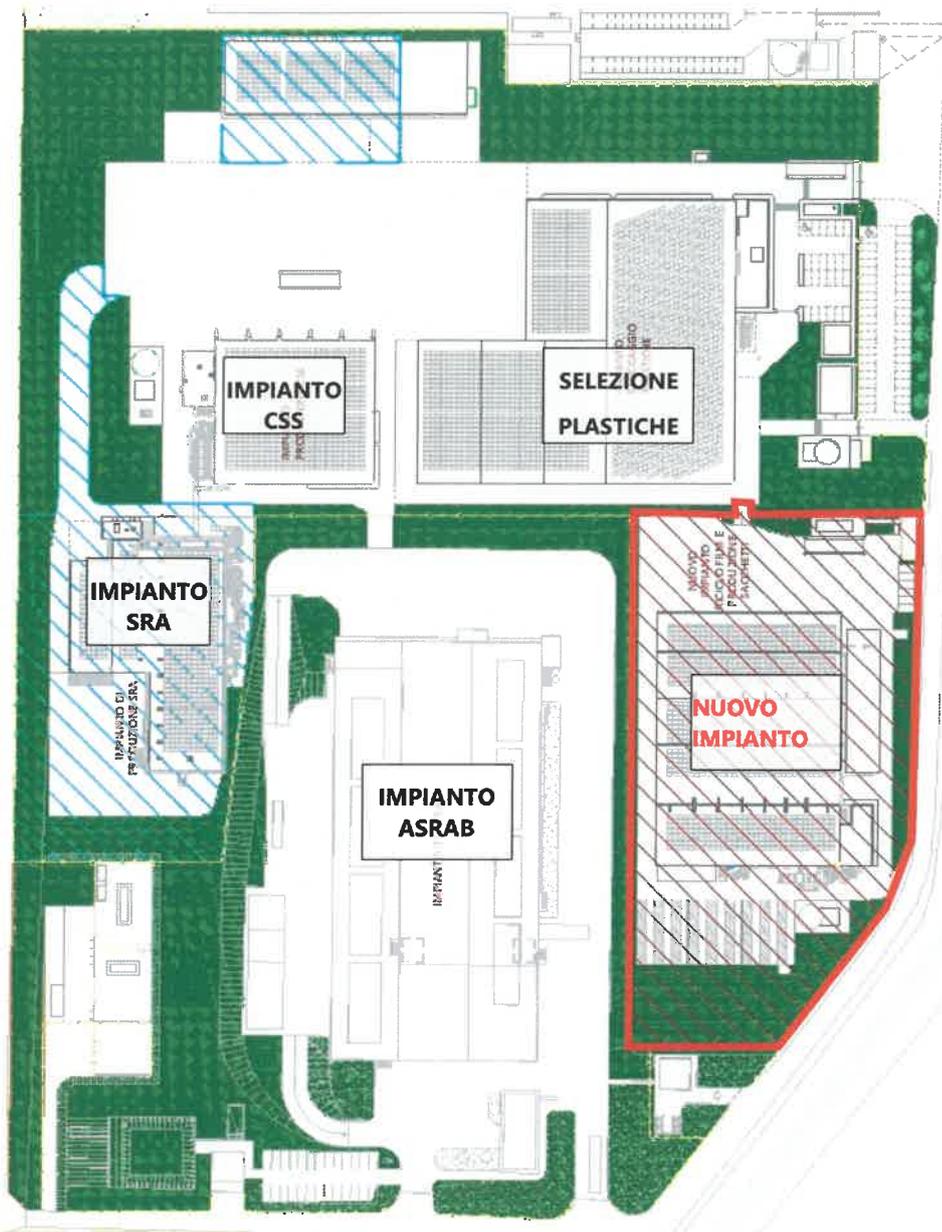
Planimetria generale degli impianti esistenti con l'indicazione della nuova area di intervento "NUOVO IMPIANTO RICICLO FILM E PRODUZIONE SACCHETTI" (in rosso)
